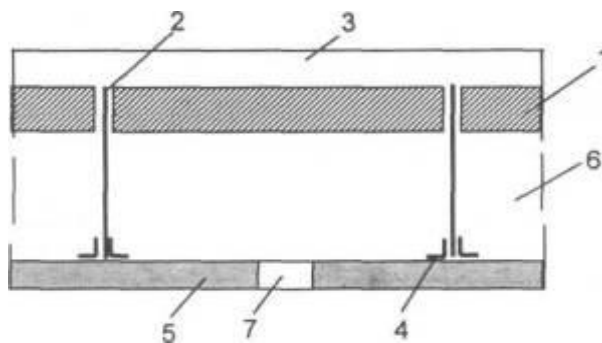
Залізобетонне перекриття з підвісною стелею:
